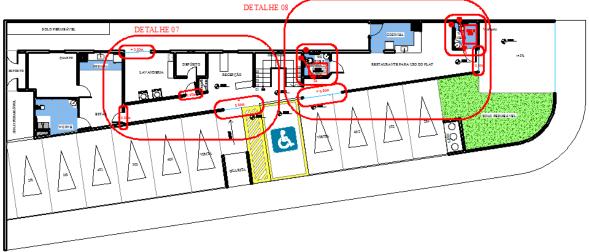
Planta Baixa - Pavimento térreo (4)
